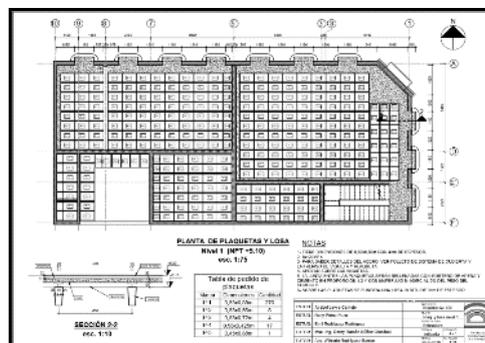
133 Plano de plaqueta y losa nivel 1.
